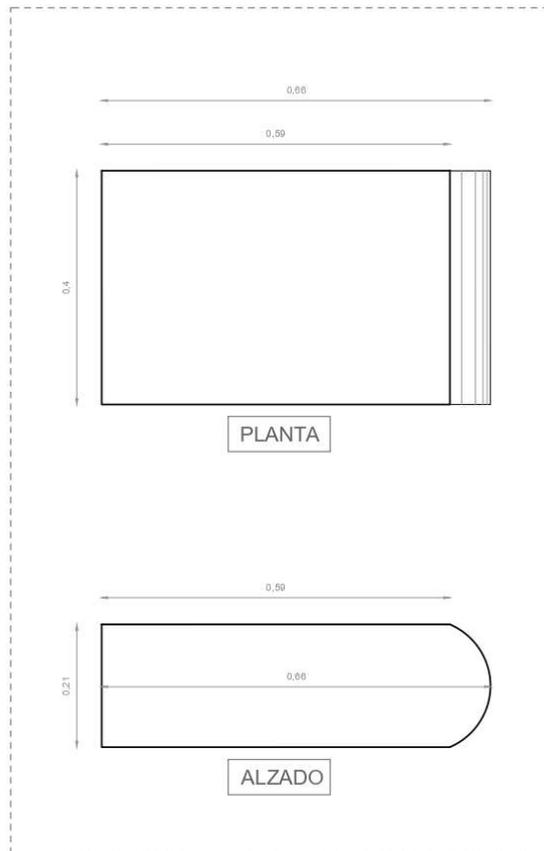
Ficha técnica que muestra las dimensiones del cordón del fuerte de Santa Cruz (S.M).
